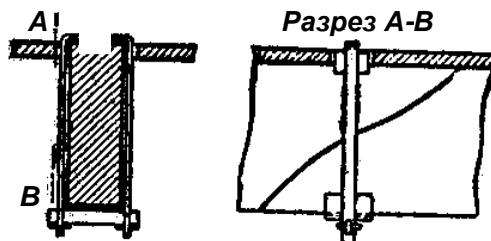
Усиление железобетонных балок хомутами из полосового железа
